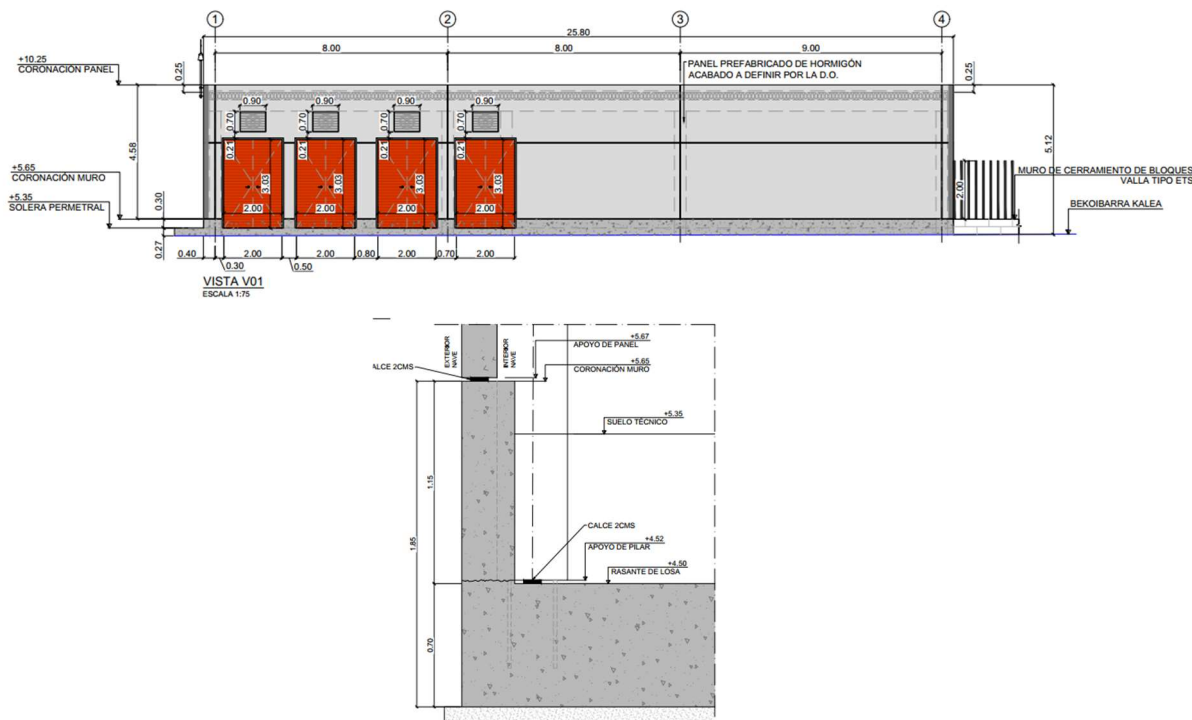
Detalles arquitectónicos. Fachada y muro de semisótano)
